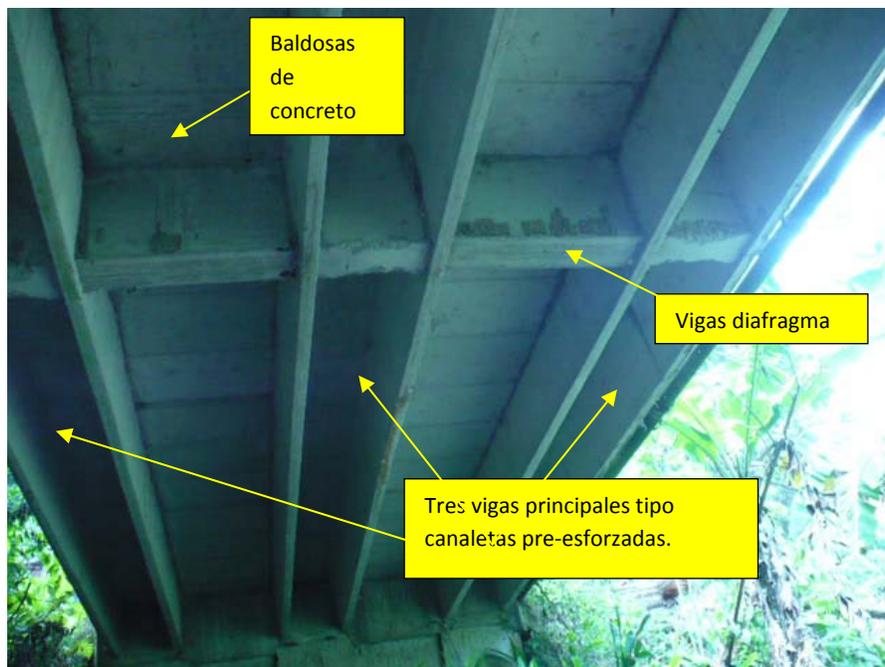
Sistema de vigas principales preesforzadas, vigas secundarias y baldosas.
